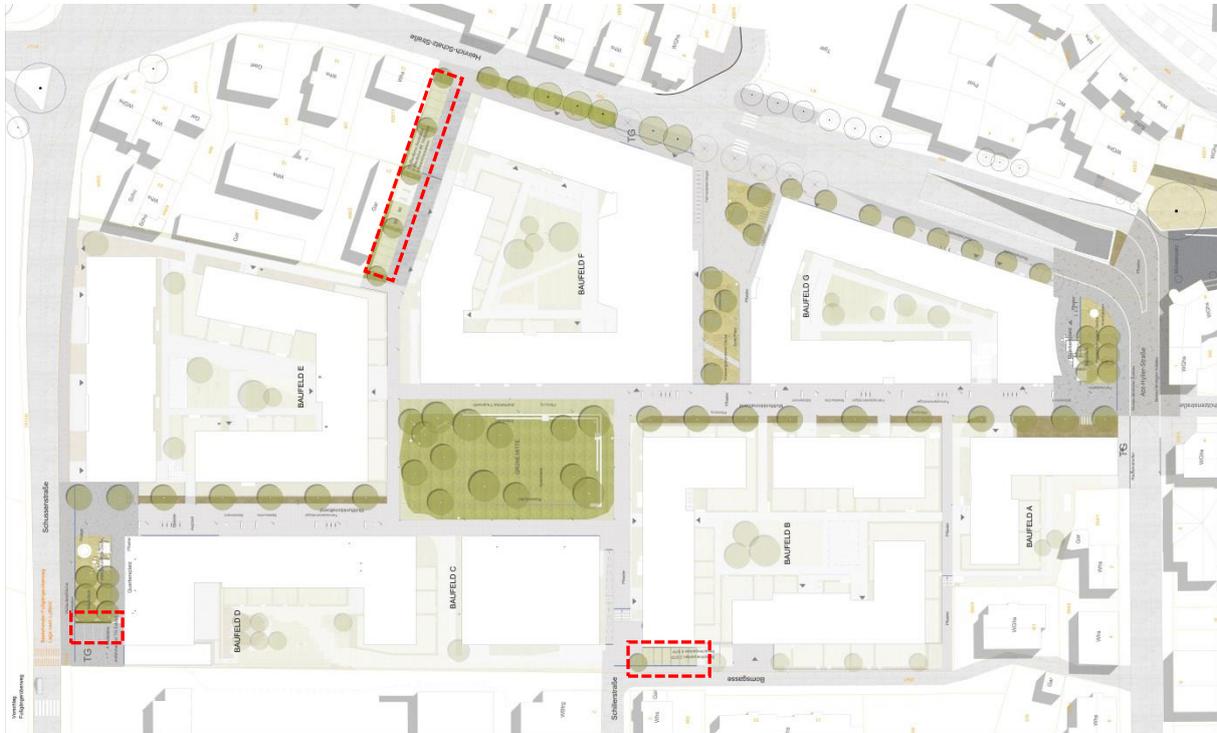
Lageplan mit Darstellung der Bereiche der öffentlichen Besucherstellplätze
